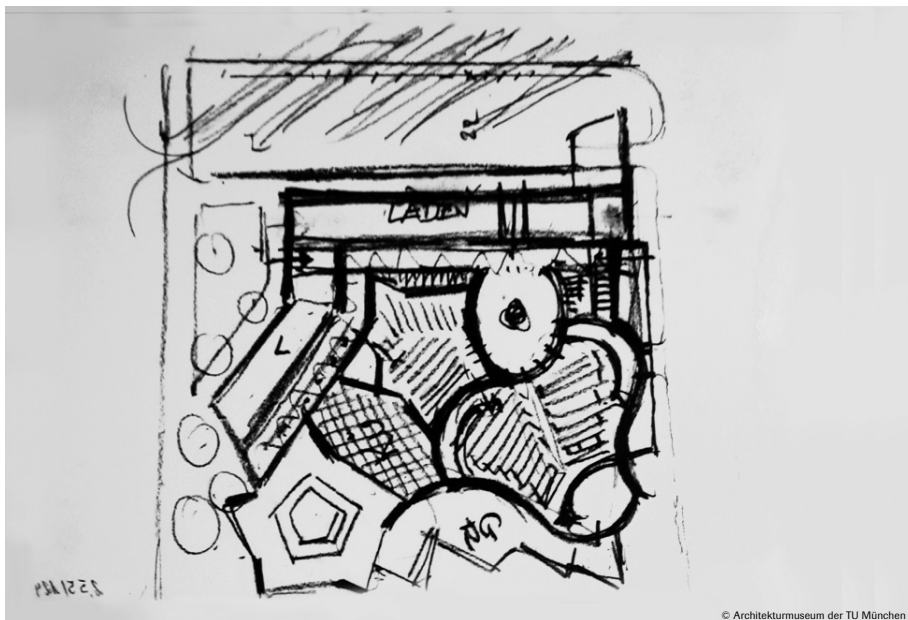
Keplerbau Grundrisskizze Gesamtkomplex, Adolf Abel, 1959.
